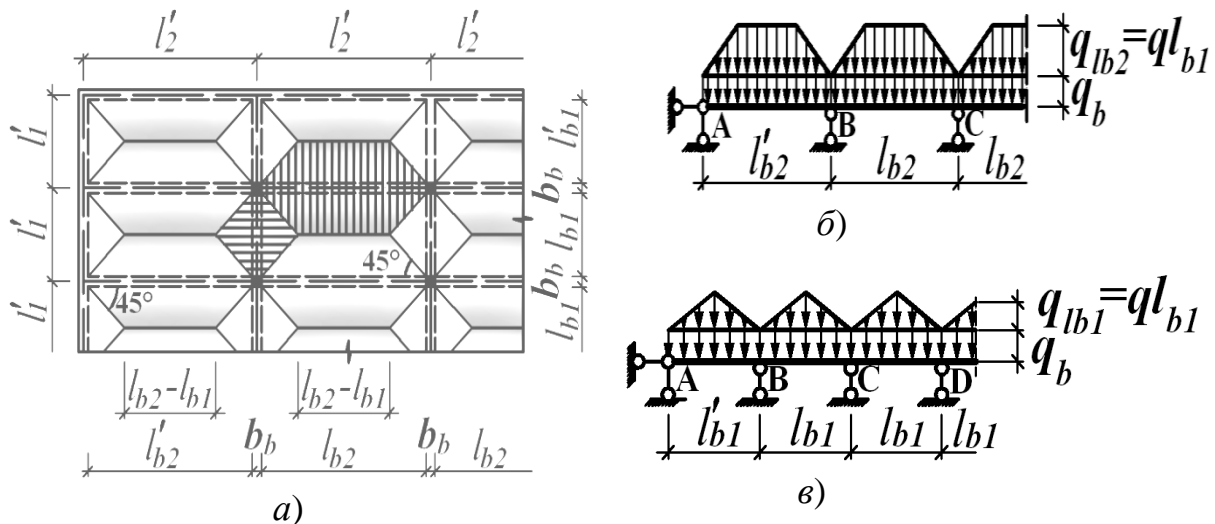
До розрахунку балок перекриттів з плитами, опертими по контуру:
